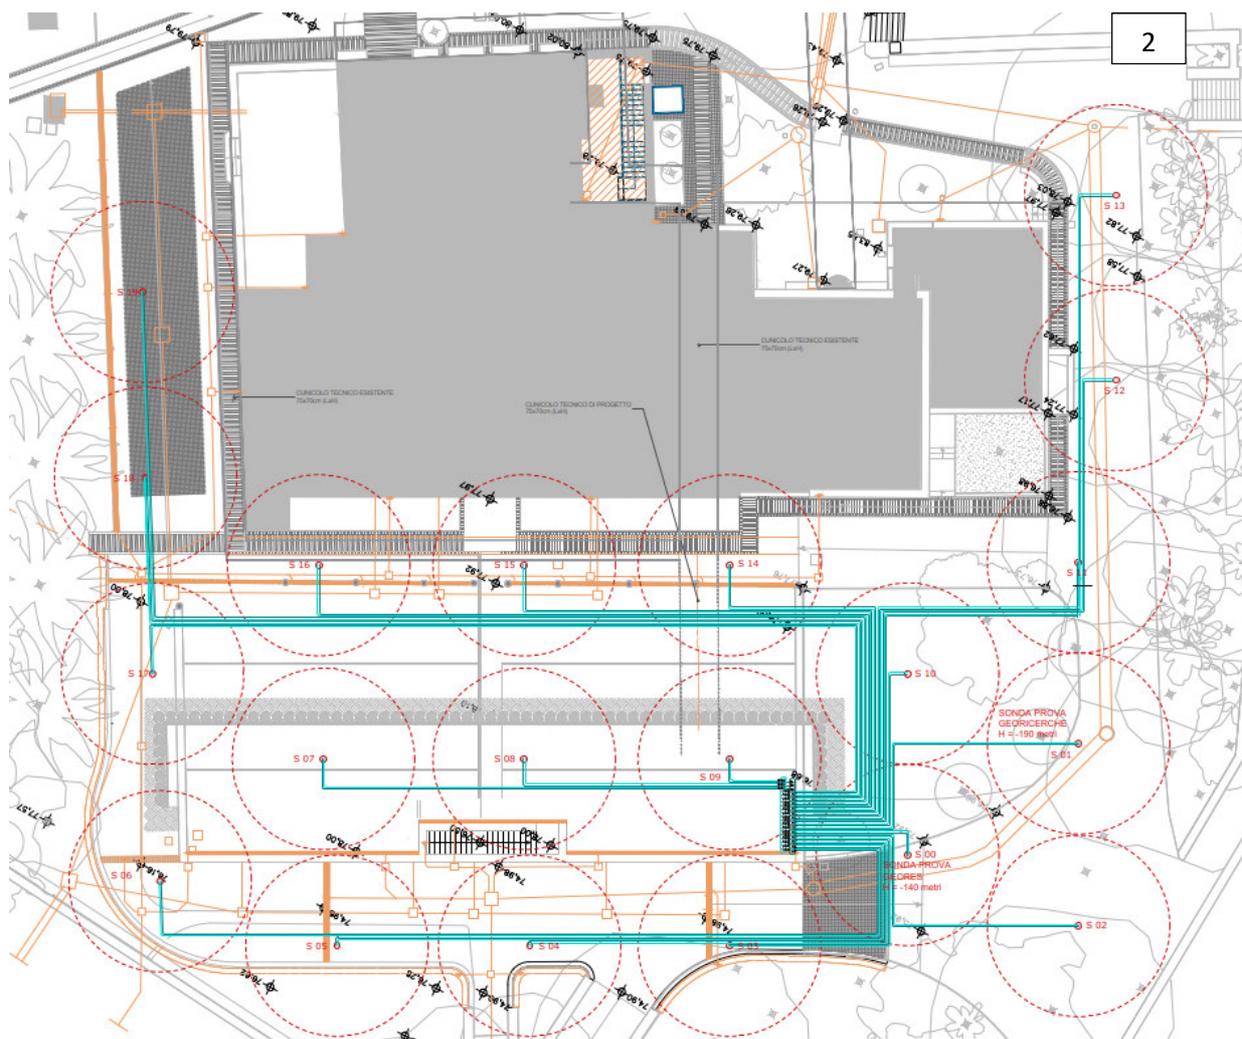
Bauplan der Botschaft mit den ursprünglich vorgesehenen 20 Erdwärmesonden
